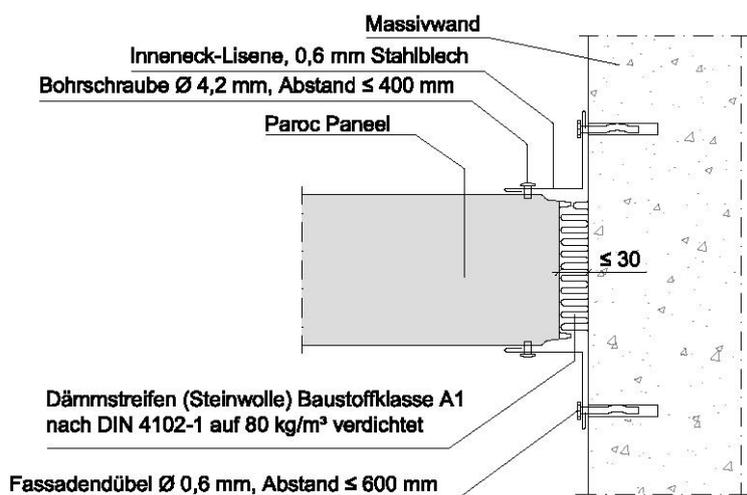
Detail konstruktiver Trennwandanschluss an Massivwand
